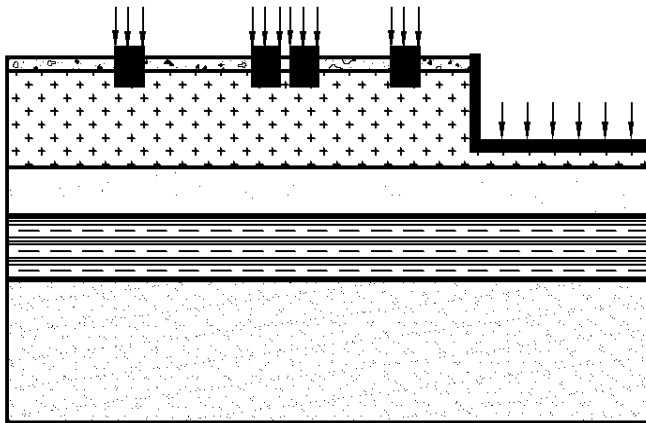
Расчетная схема участка с наиболее неблагоприятным влиянием фундаментов
